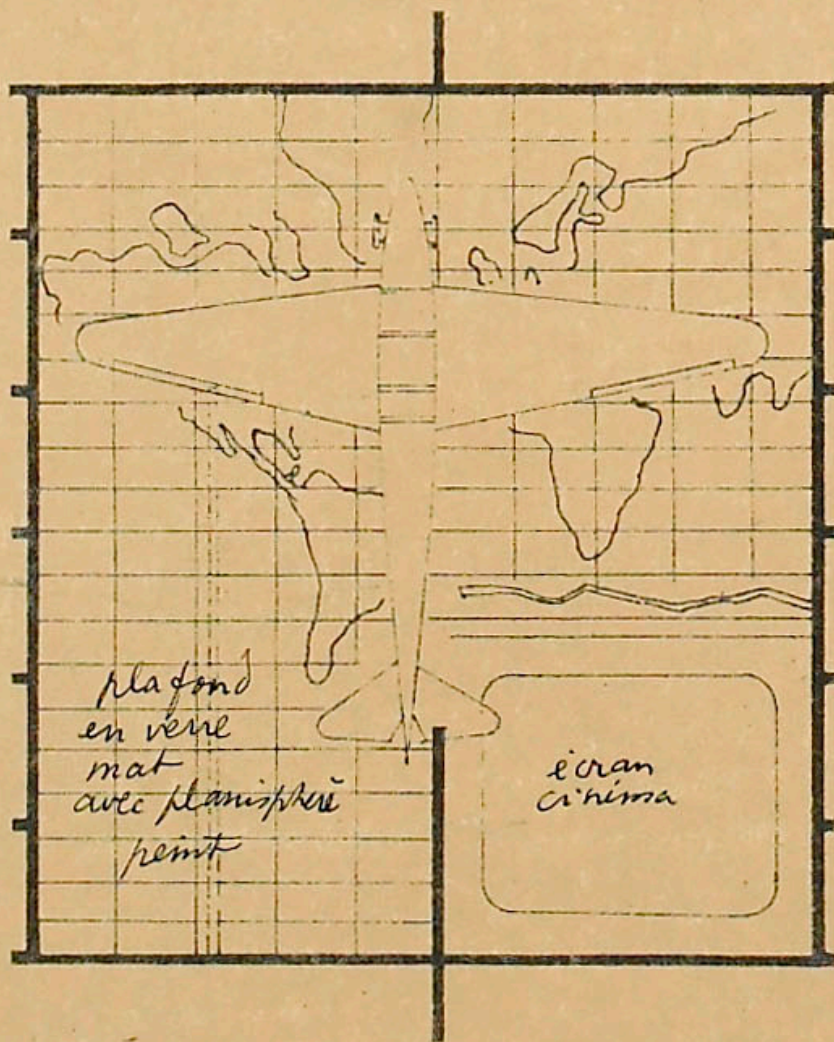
Planta Baixa e Planta de forro com planisfério e tela de projeção de cinema. Reprodução parcial do documento FLC 17813.
